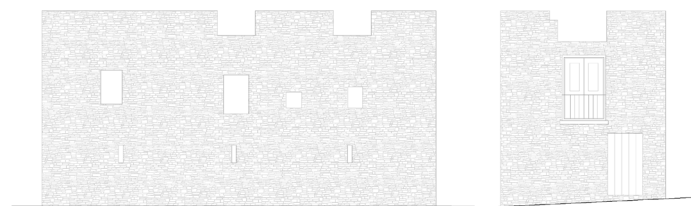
CASA SOLANO, Fachada Oeste
